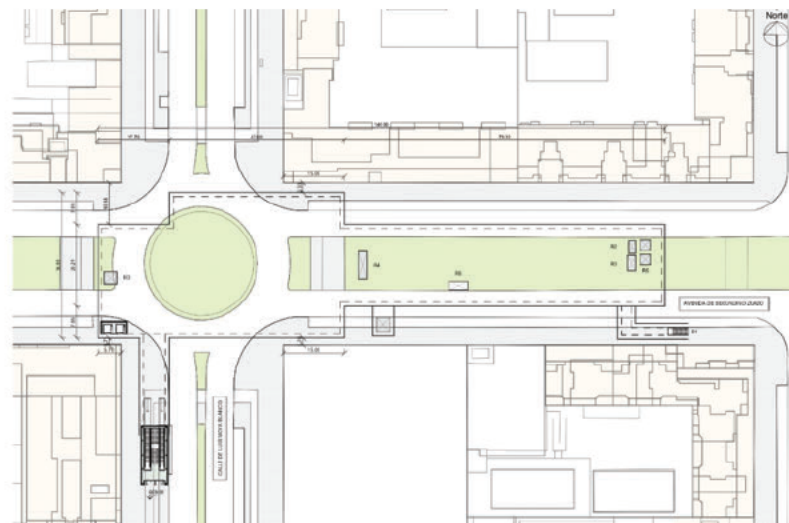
Estación Valdebebas Norte \_Planta Calle
